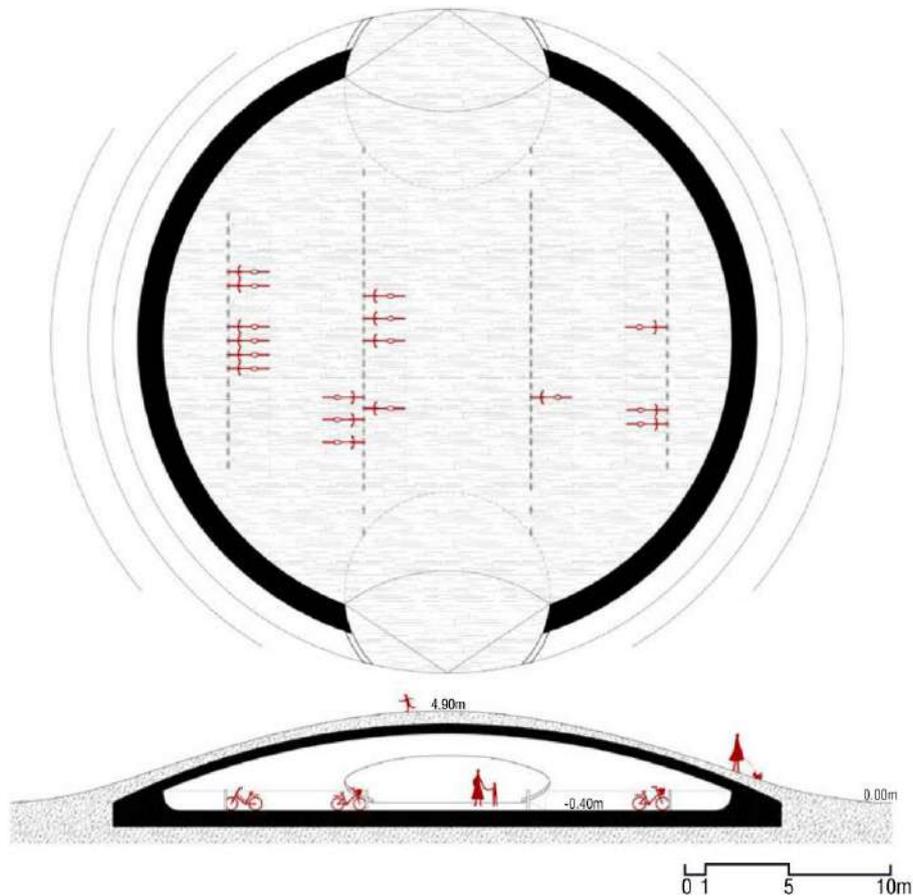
Planimetria e sezione di progetto Bike parking – Arch. Roberto Rosset
